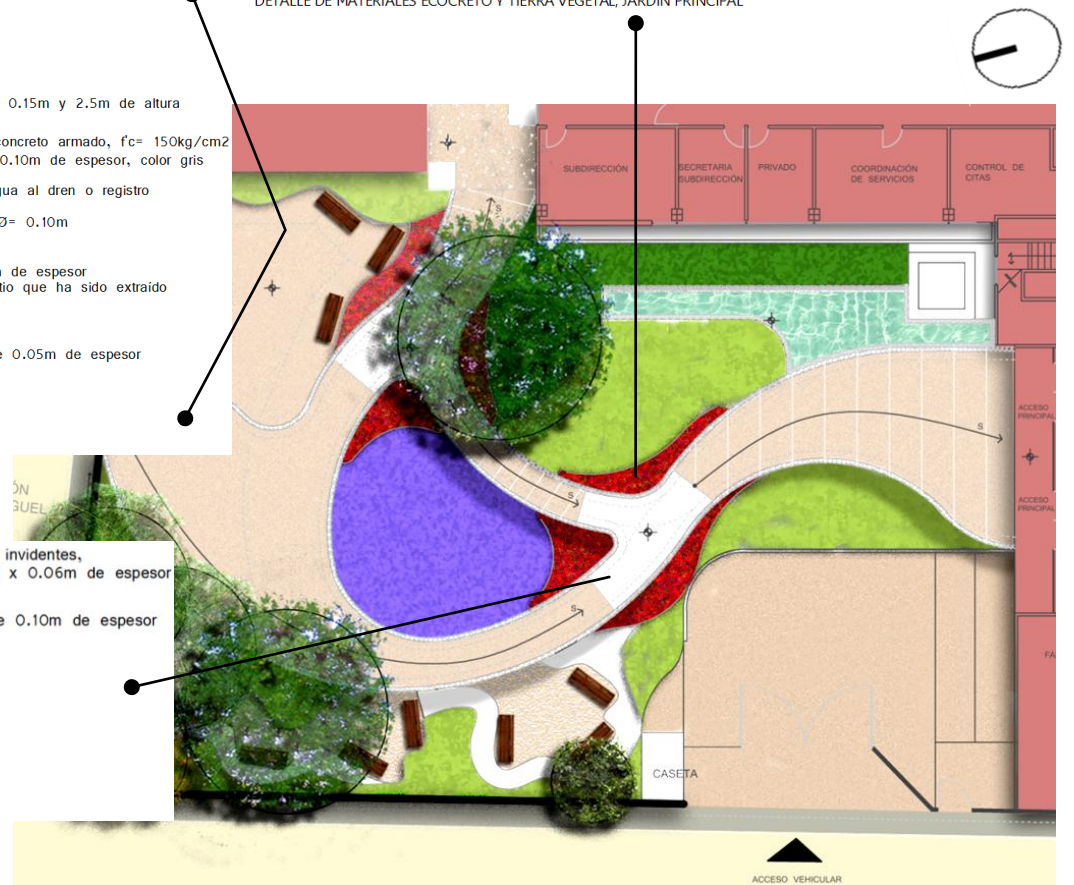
Conjunto de los detalles constructivos más significativos del proyecto Jardín Principal.
